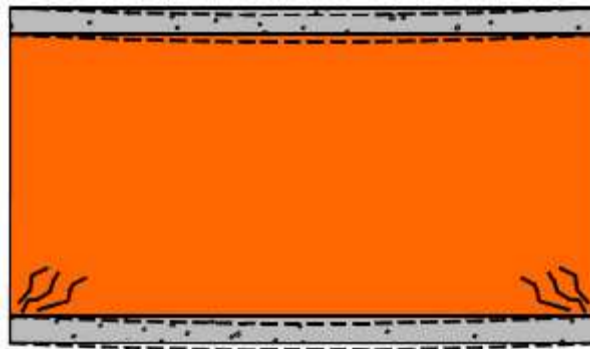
Fissuração originada pela deformação idêntica na parte superior e inferior do painel de parede.
